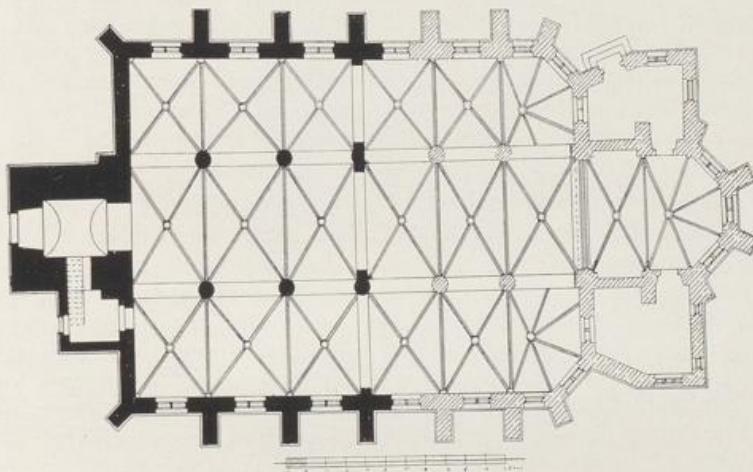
Weisweiler. Grundriss der kathol. Pfarrkirche.
